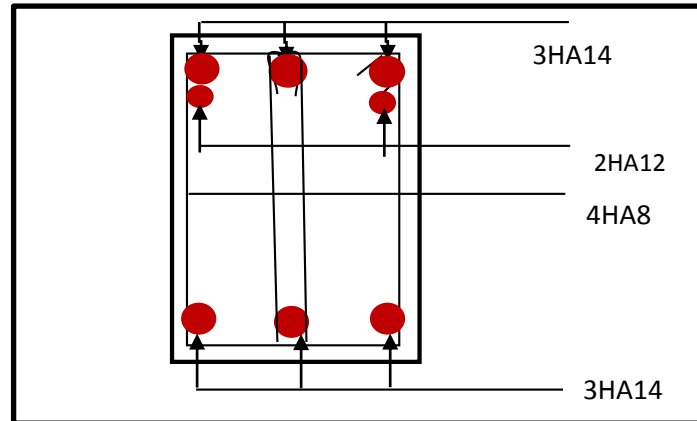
Ferrailage en travée d'une poutre principale.
